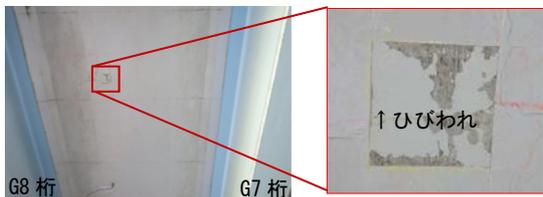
RC床版下面GFRP撤去位置の床版ひびわれ
